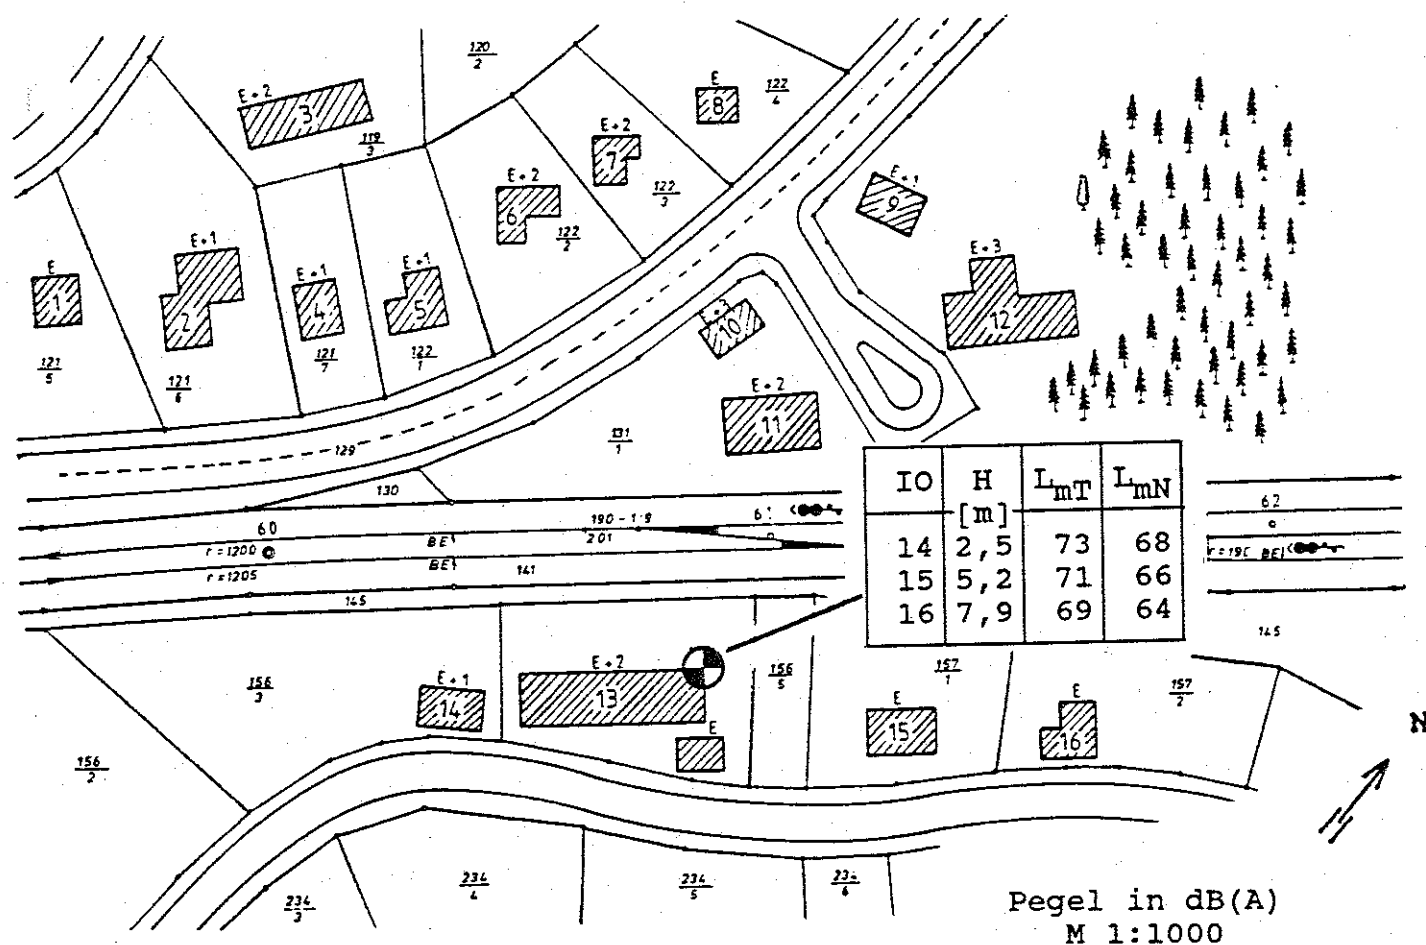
Lageplan mit Immissionsorten und Gesamtbeurteilungspegeln
